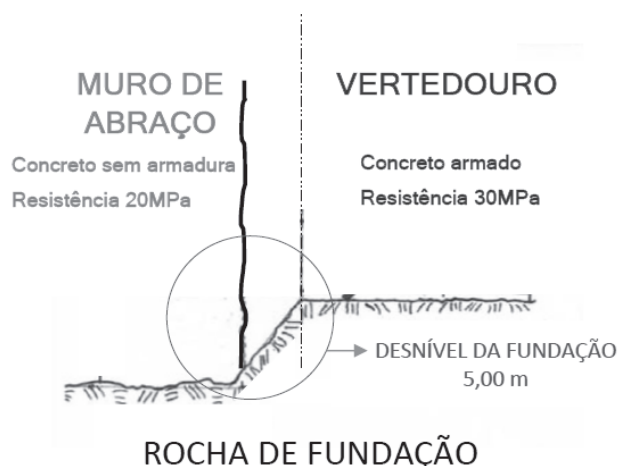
Transição dos tipos de concreto na região da fissura, fonte: CREA (2016).
